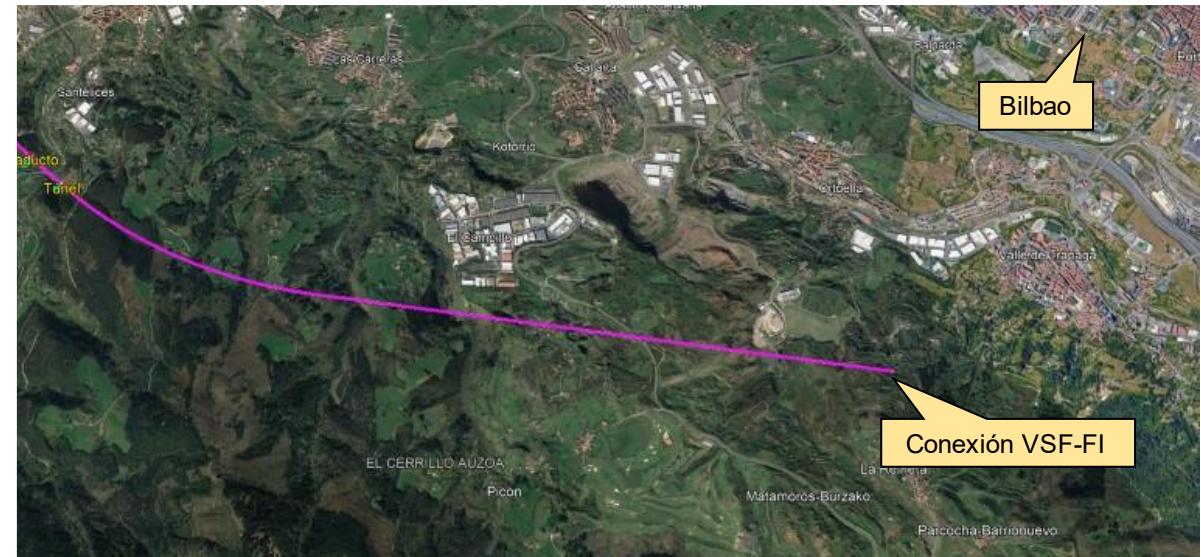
Trazado en planta Alternativa A1 en el entorno de la Conexión VSF-FI
